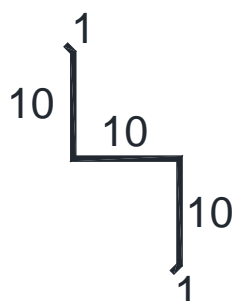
Perfil do rufo a ser instalado nos ressaltos existentes entre a platibanda e a parede externa.
